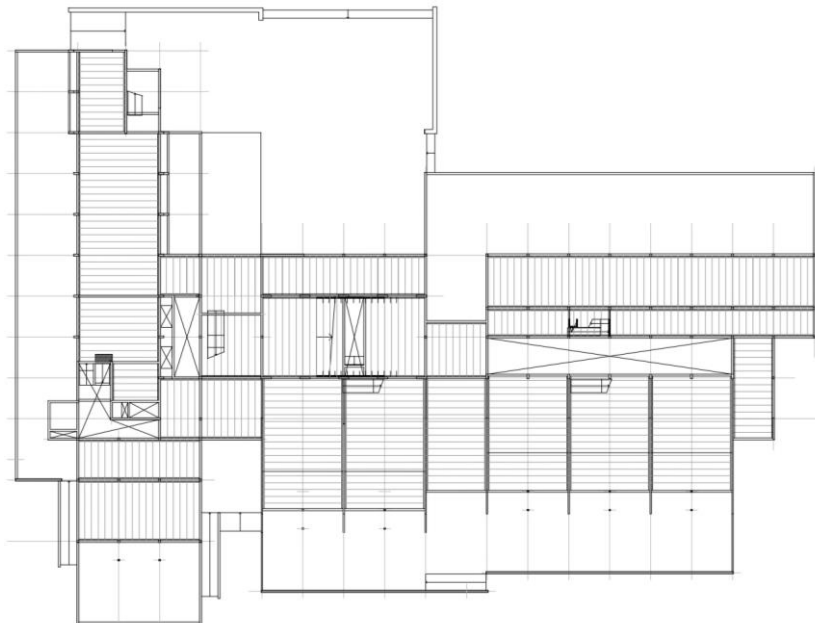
Planta baja estructural. Fuente: elaboración propia a partir de planos originales
